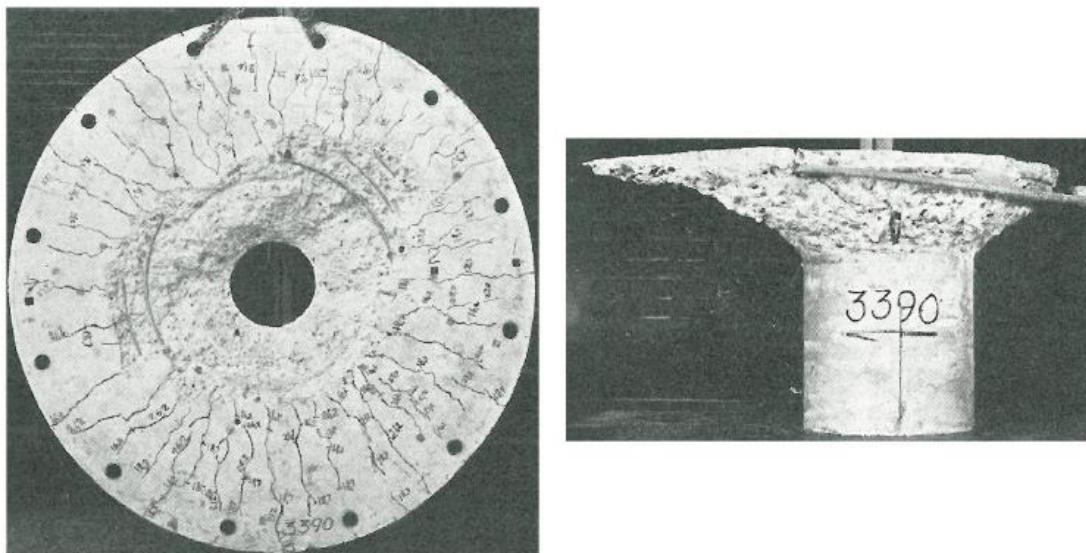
Porción de losa fuera de la fisura (izquierda); Porción cónica delimitada por la fisura de punzonamiento(derecha), ensayos realizados por Kinnunen y Nylander (Ericsson & Farahaninia, 2010).
